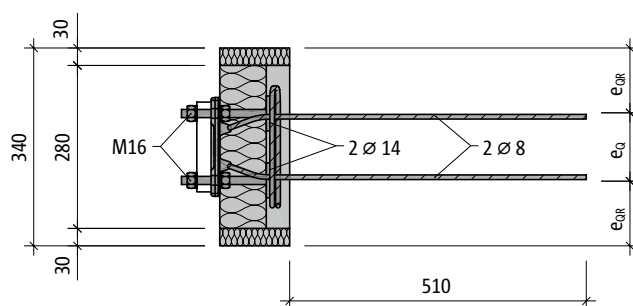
Schöck Isokorb® RT Typ SQ-V1: Produktgrundriss
